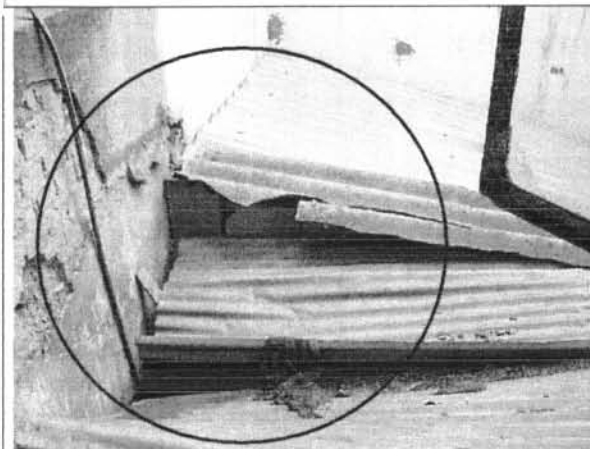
Hay caída de tejas y laminas de cubierta en el costado sur del inmueble - Zona patio.
